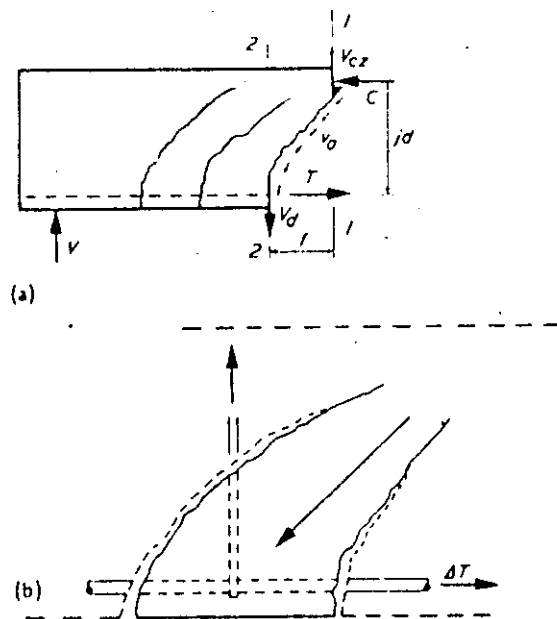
Mecanismo resistente al cortante en la viga. a) Las fuerzas internas resisten el cortante, sin que exista refuerzo en el alma, b) voladizo en el concreto que actúa como puntal, con la existencia de refuerzo en el alma.
